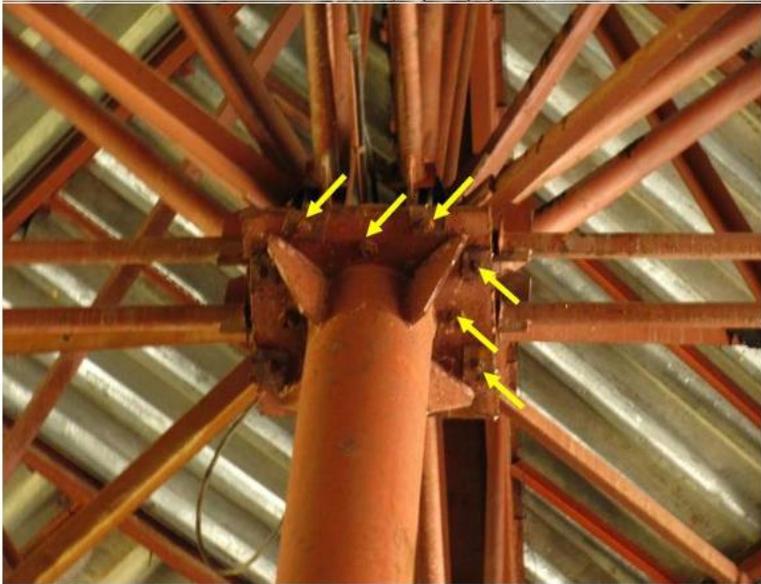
Кріплення просторових блоків до опорної пластини центральної колони на болтах з накладками.
